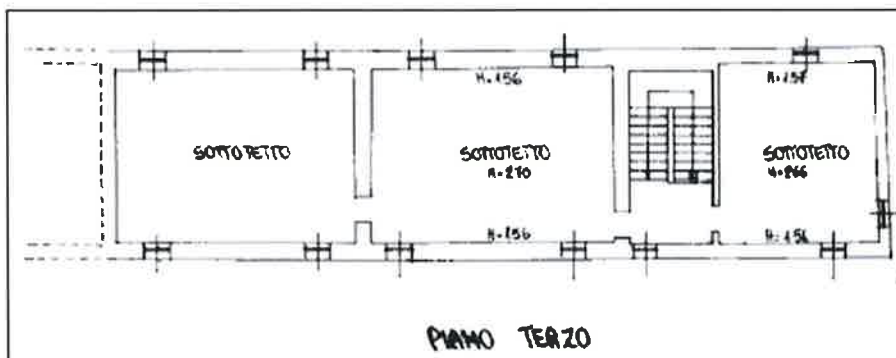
planimetria catastale del piano terzo dell'abitazione identificata con la particella 1184 sub 5
